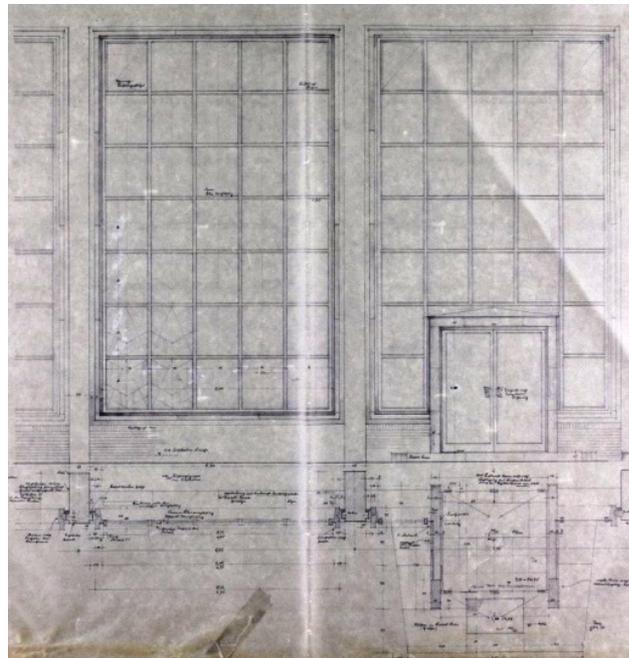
Konstruktionszeichnung für den Seiteneingang, Grundriss (Ausschnitt), O. Hodler, undatiert
